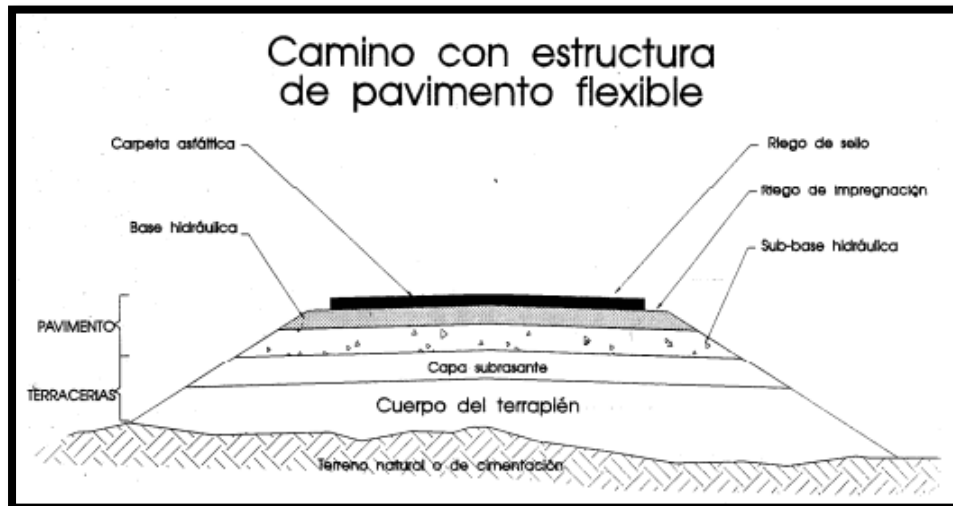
Esquema del sistema estructural de un pavimento flexible
